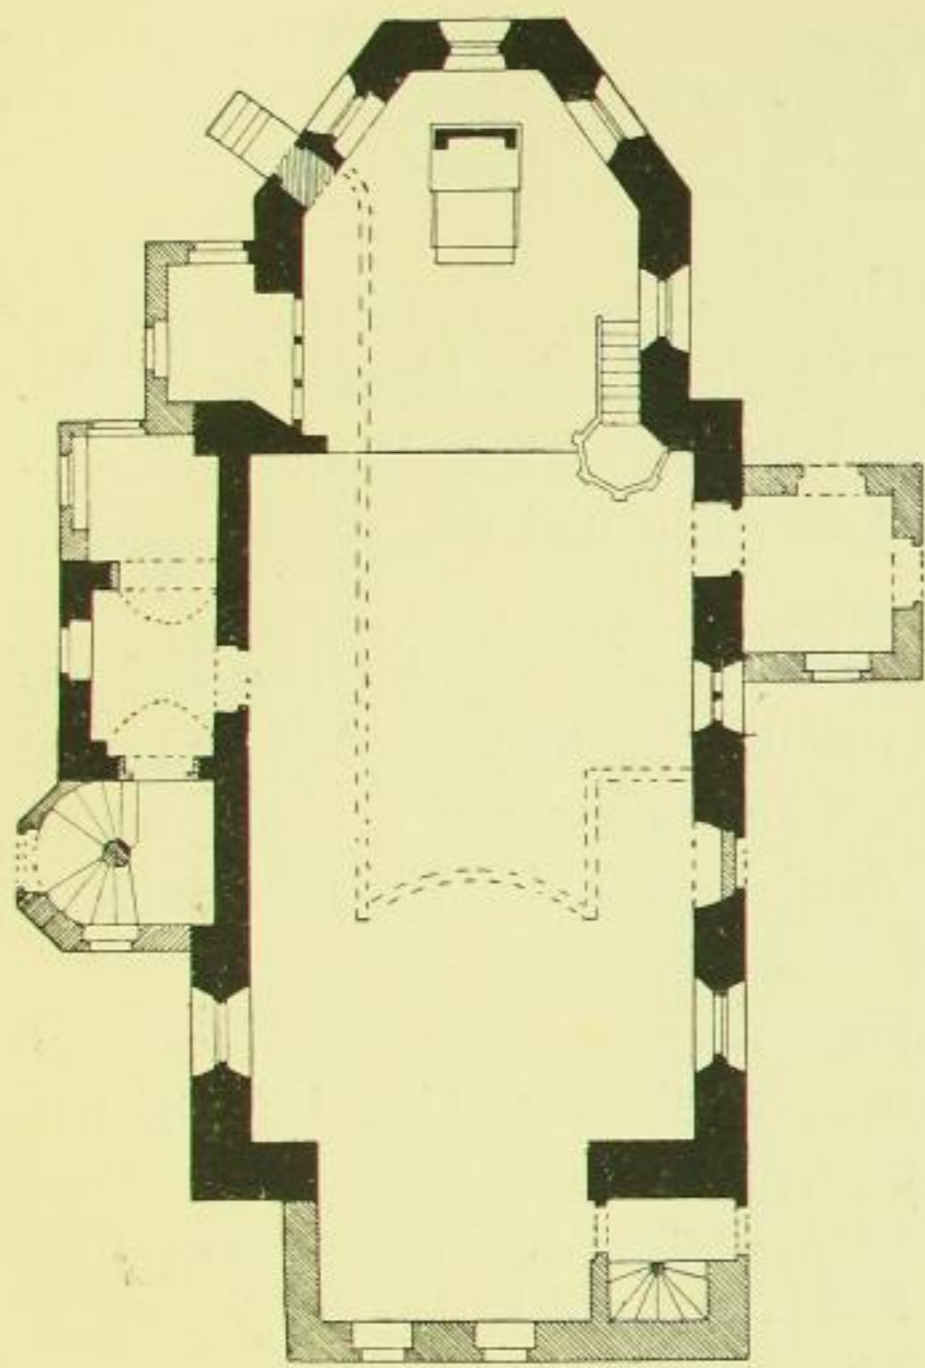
Rabenau, Grundriss der Kirche.
